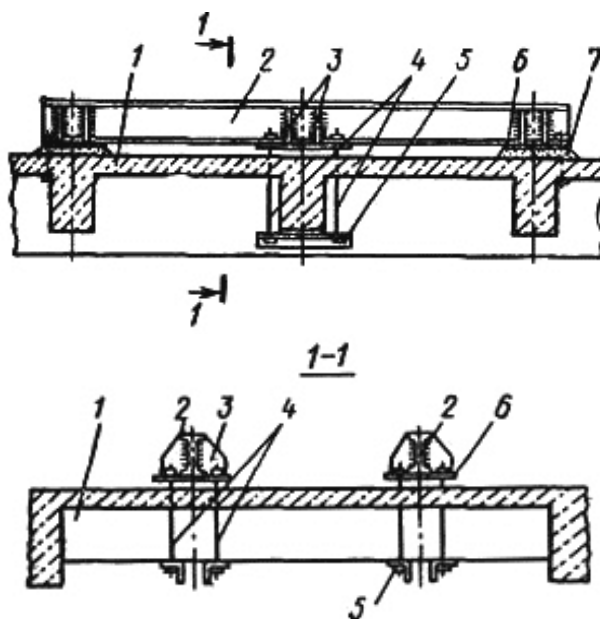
Усиление балки и плиты перекрытия металлическими балками сверху: 1 – разрушаемая балка; 2 – металлическая балка; 3 – ребра жесткости; 4 – тяжи; 5 – планка; 6 – опорные листы; 7 – опорные подушки
